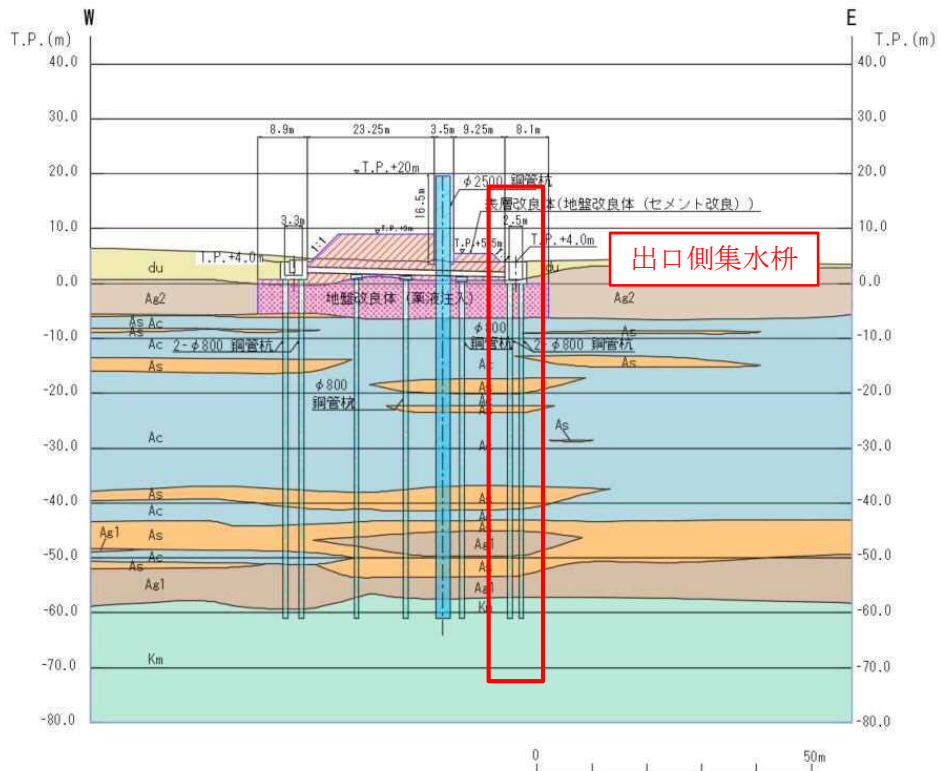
評価対象断面図 (排水系統 I-2)
